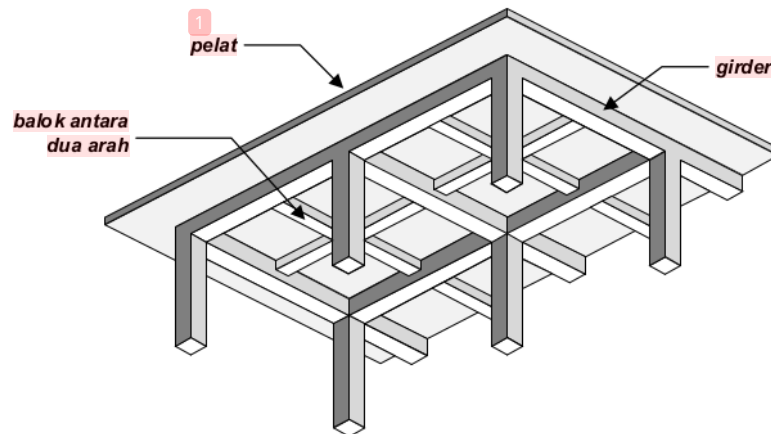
Sistem lantai slab di atas girder.
